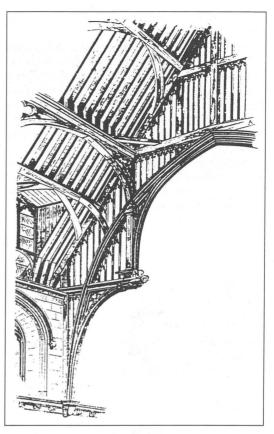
Westminster Hall según Viollet-le-Duc, Londres (1394-1402).
